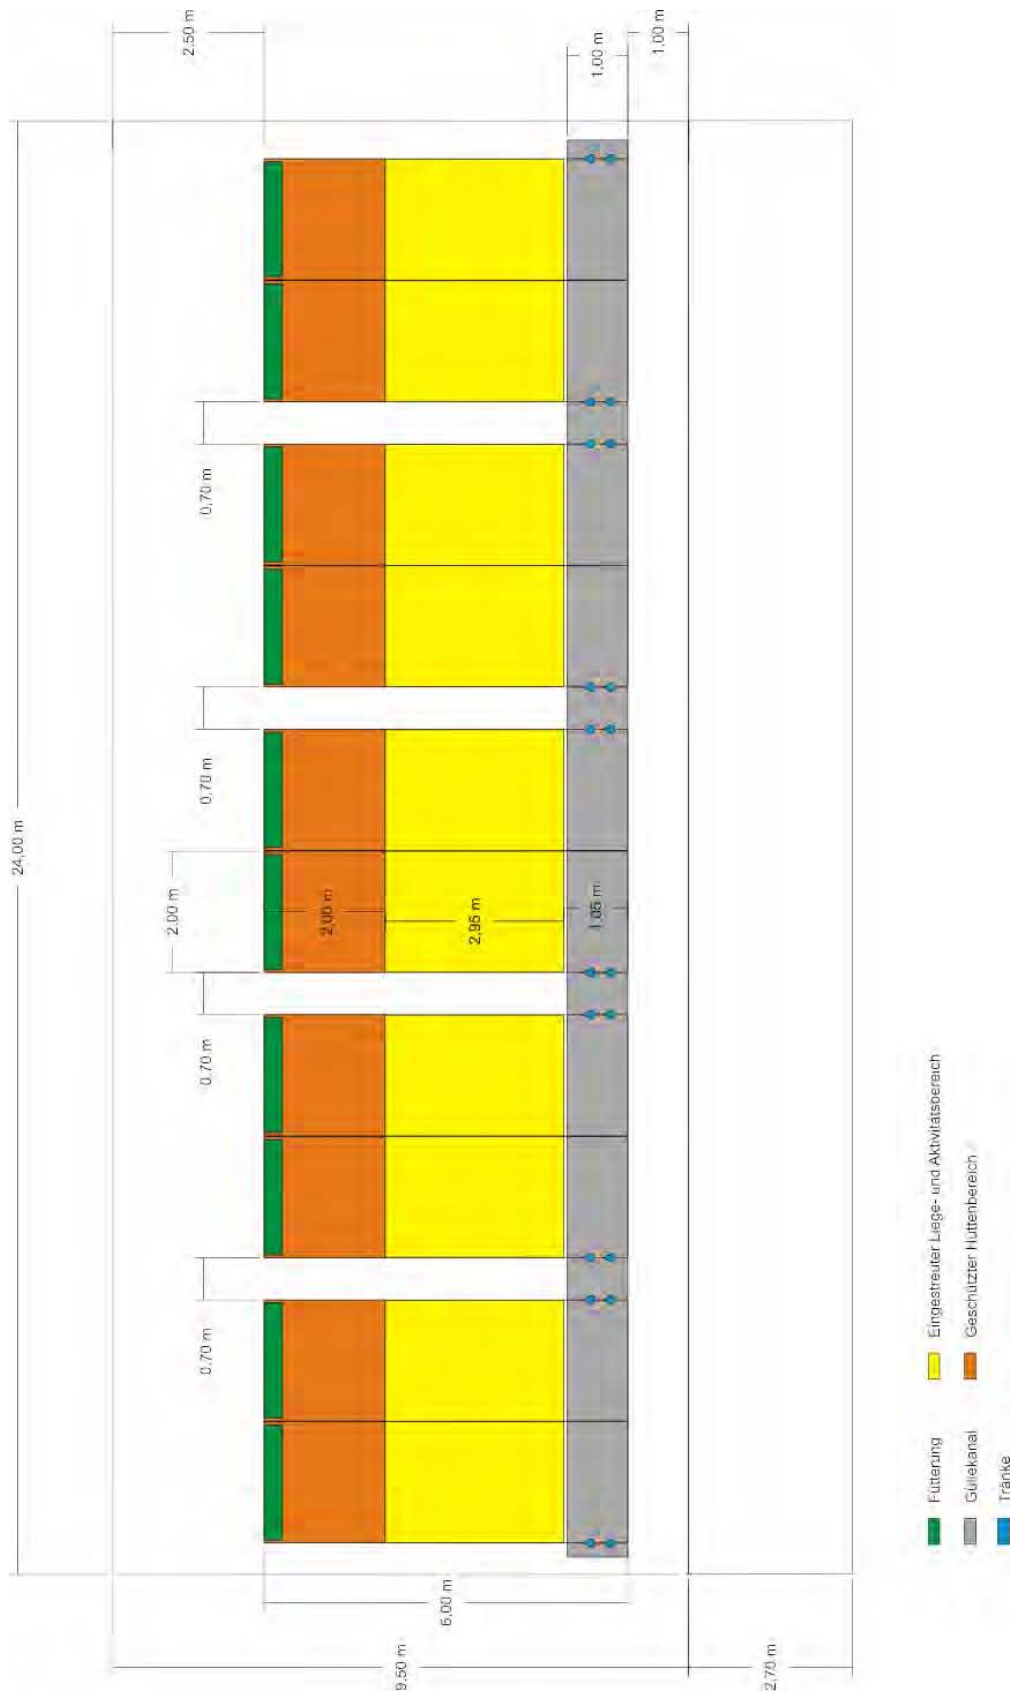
Grundriss Offenfrontstall mit modifizierten Koomansbuchten
